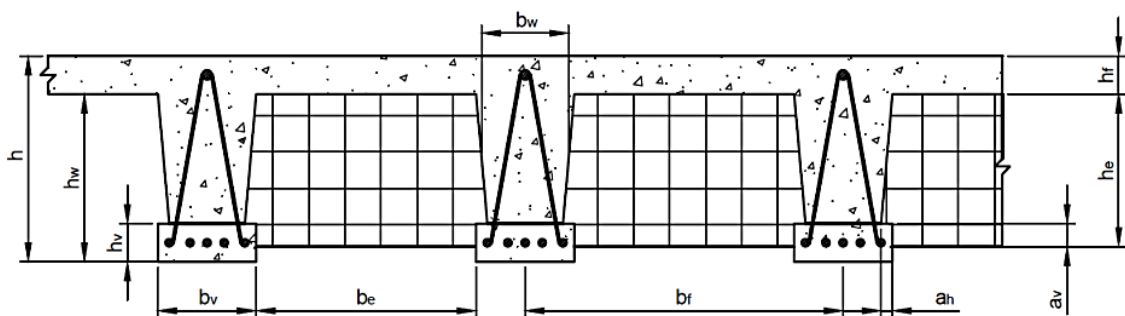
Seção típica de laje treliçada e suas principais dimensões. (Fonte: Machado, 2017)
